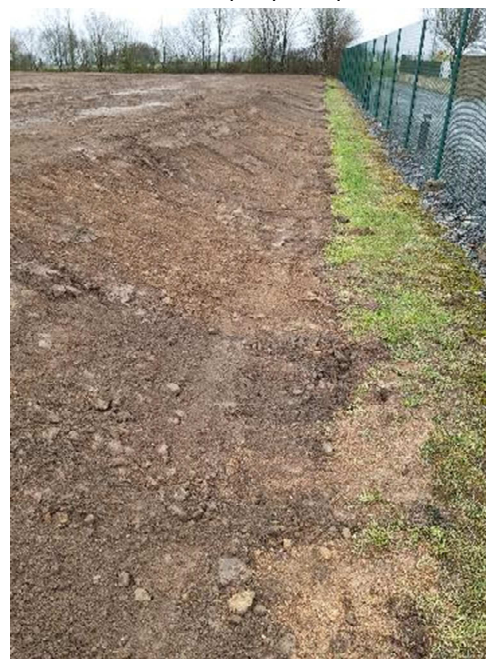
Bord Sud du confinement, recouvrement par la terre végétale – vue vers l'Est
